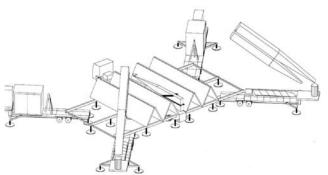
Pabellón Itinerante IBM. Vista Interior. Fuente: www.arquitecturamashitoria. blogspot.com
